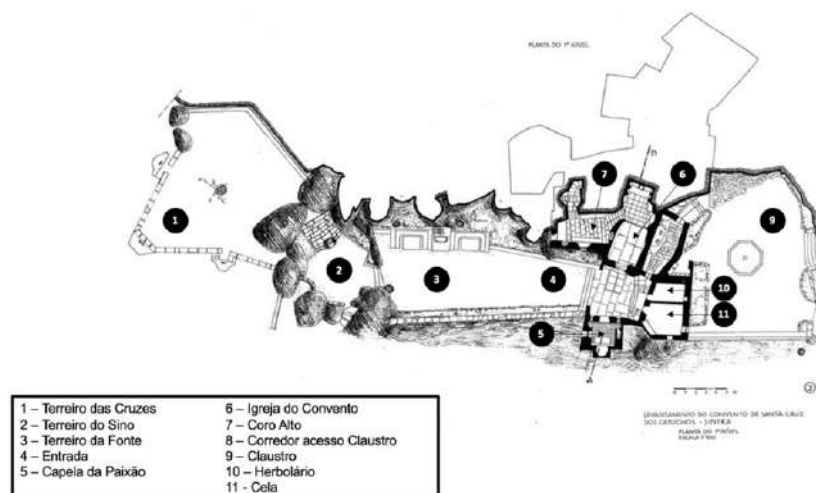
Planta do 1º nível do Convento. Adaptado de (Gamito & Soares, 1964).
